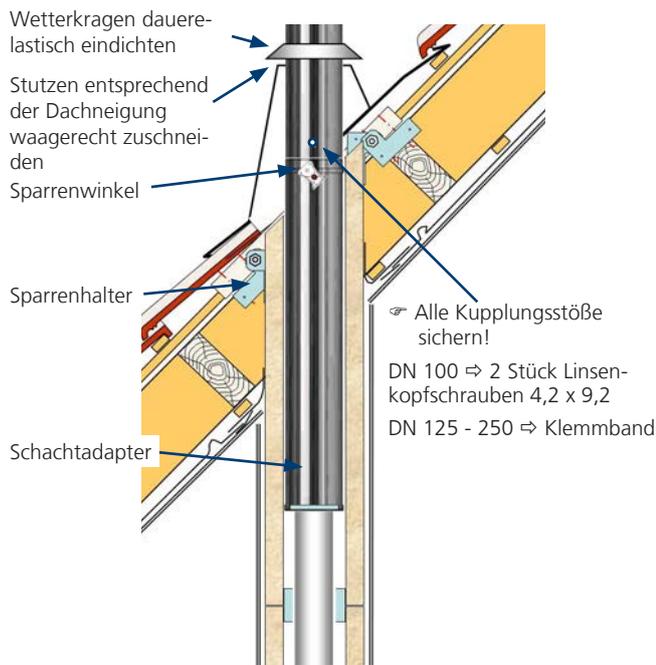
Schnitt Dachdurchführung DN 100 bis 250
